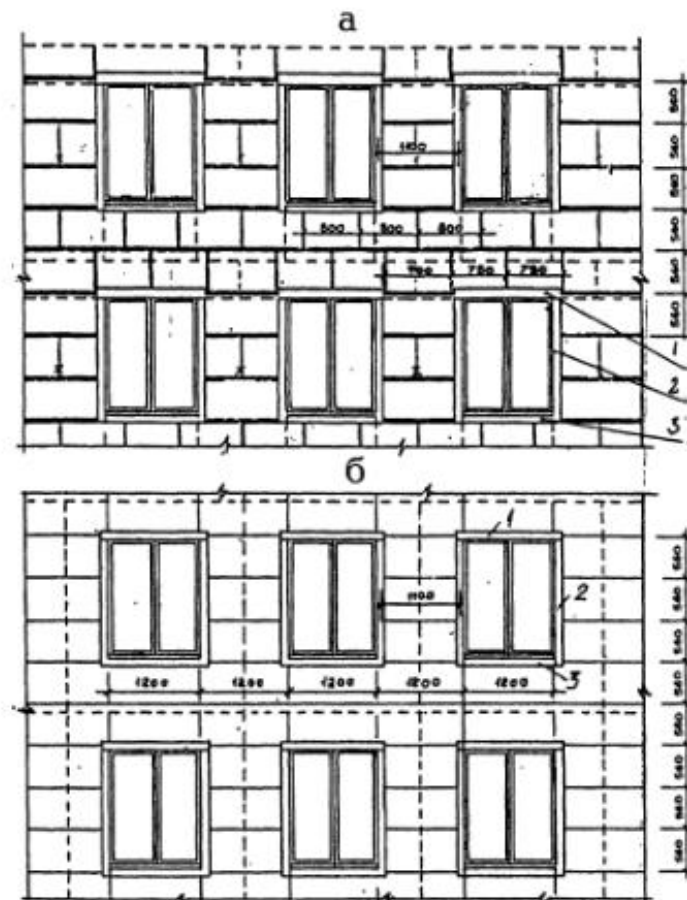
Примеры раскладки облицовочных плит на фасадах: а – крупноблочных домов, б – то же панельных: 1 – верхний элемент обрамления проема, 2 – то же, боковой, 3 – то же, нижний
